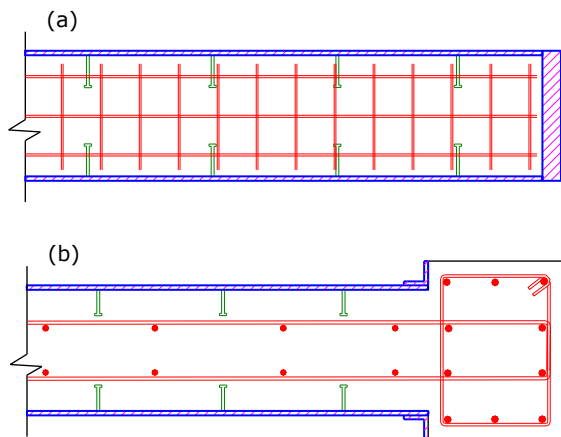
Ejemplos de secciones típicas de (a) muro de corte relleno de hormigón y (b) muro relleno con elementos de borde de hormigón armado.
